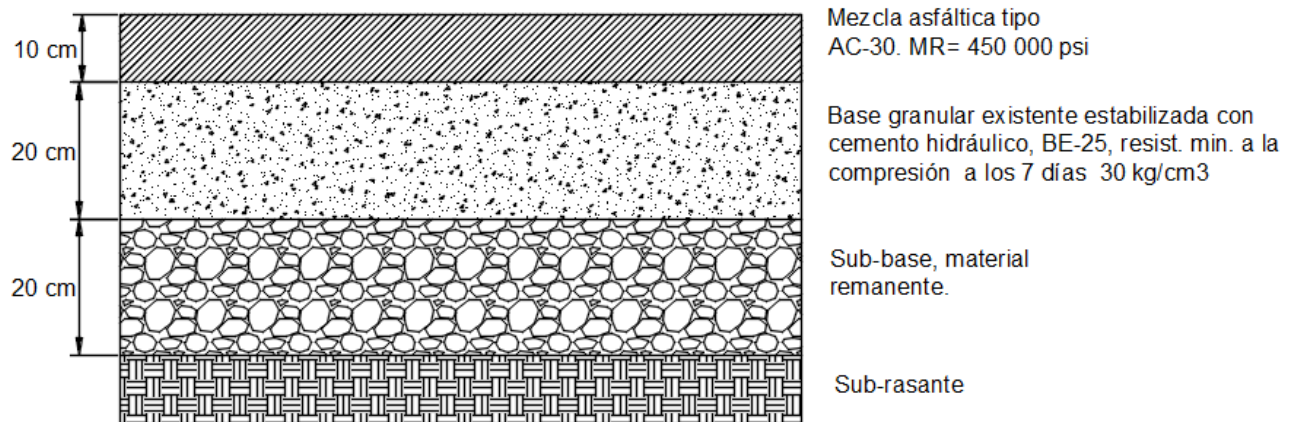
Perfil de la estructura de pavimento propuesta para el TH=36, P#1-P#4.
